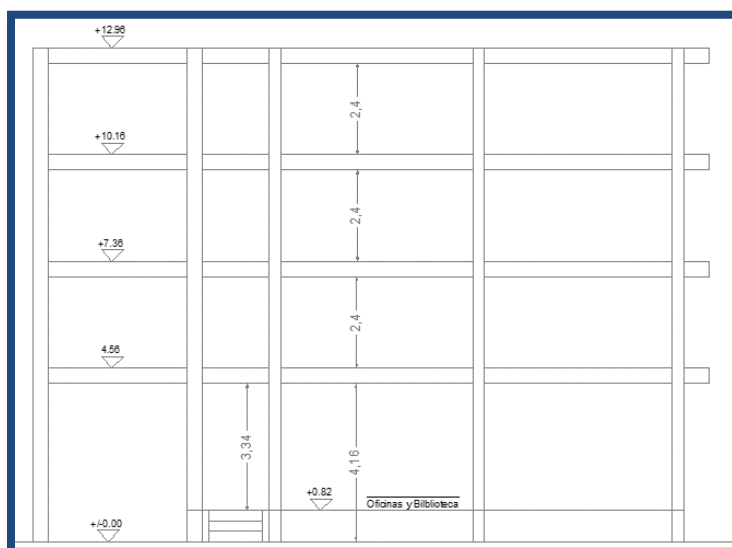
Alzado estructural típico edificio #2. Fuente: Levantamiento estructural
